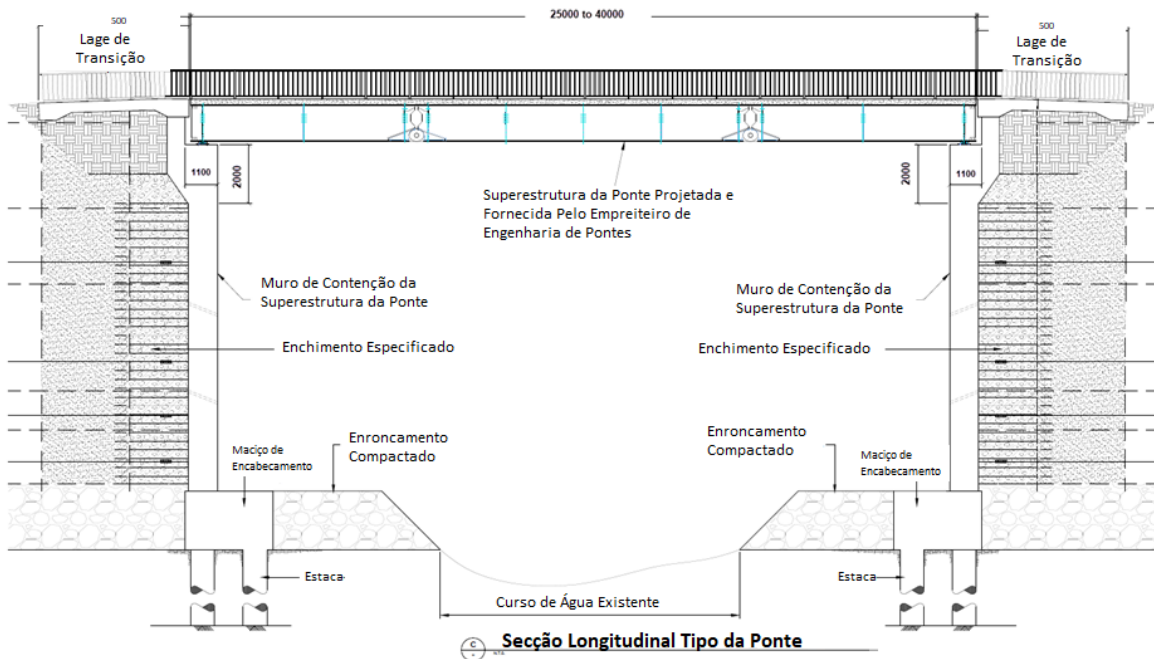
Detalhe da secção longitudinal da construção da ponte.
